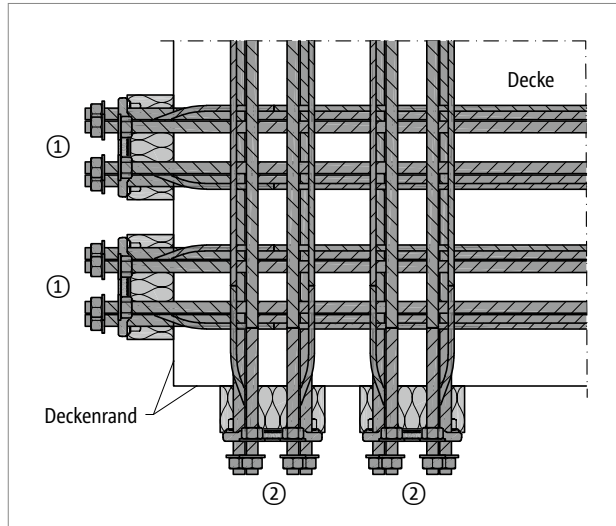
Schöck Isokorb® T Typ SK: Aussenecke
